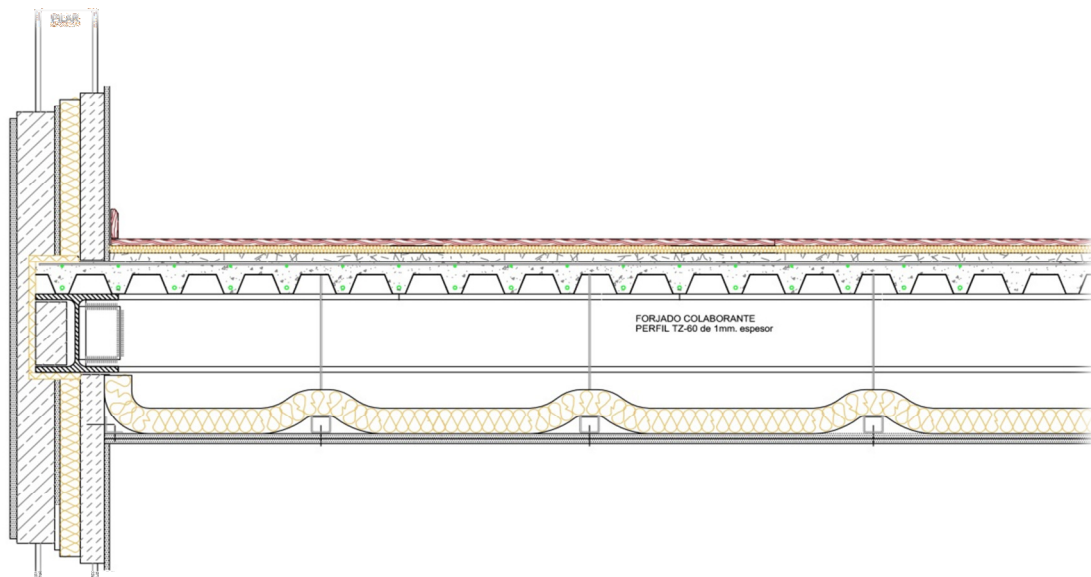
13_ Detalle constructivo del forjado, extraído del proyecto de ejecución.
